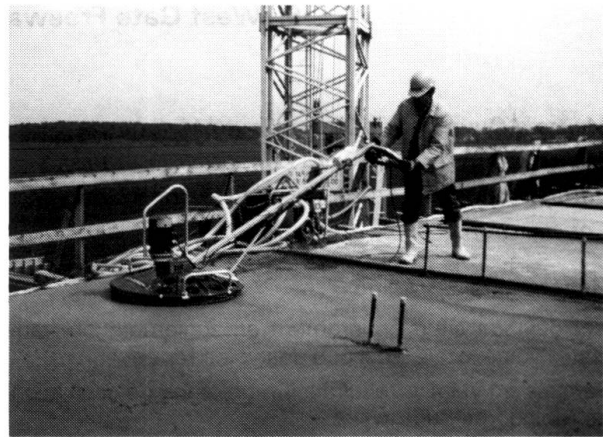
Das Abscheiben der Betonoberfläche mit Tremix Rotorplanglätter
